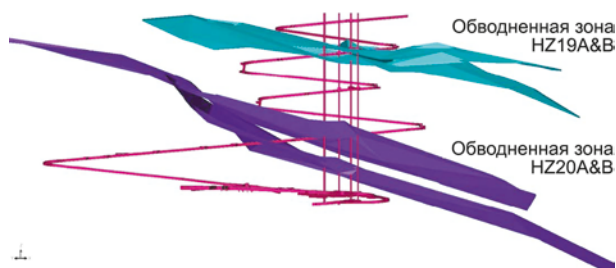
Водоносные зоны, вскрытые комплексом горных выработок ПИЛ ONKALO [35]
